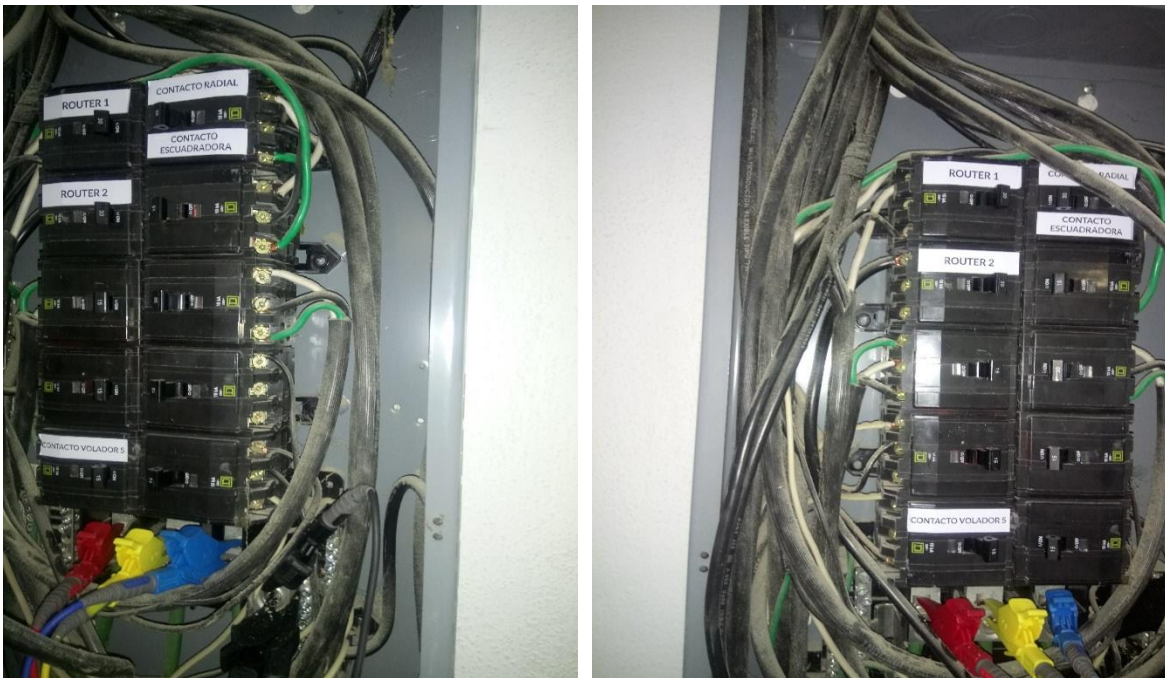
Tablero de conexión eléctrica donde se puede ver que en una fase hay más cargas conectadas.
